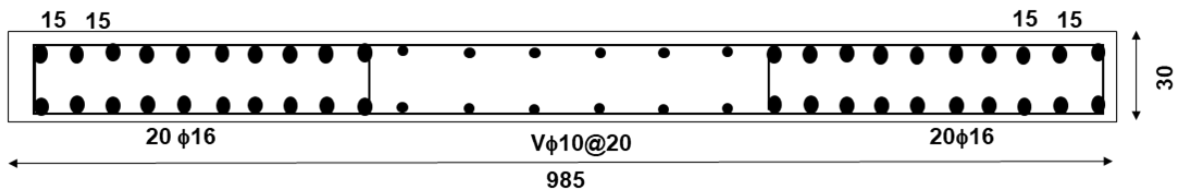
Distribución del Refuerzo Longitudinal Muros MP
